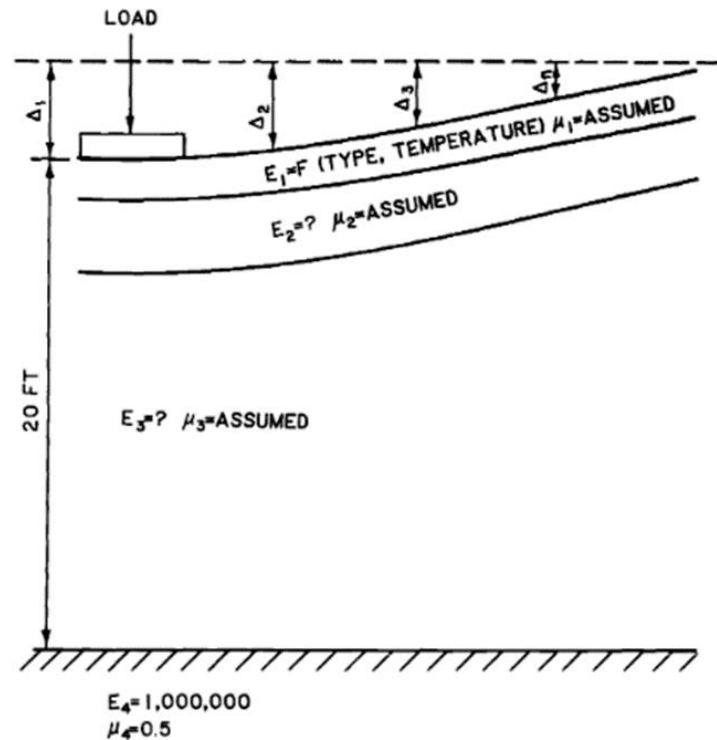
Ilustración del modelaje de multicapa elástica en el retro cálculo de pavimentos. Fuente: *Nondestructive testing of pavements*.
